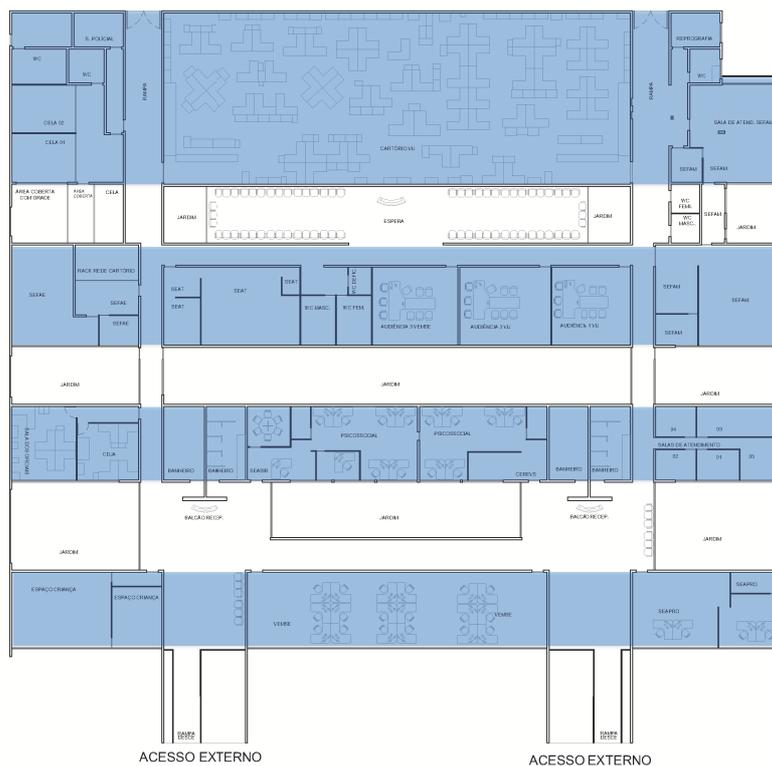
Planta baixa da VIJ TJDFT. Fonte: TJDFT.
